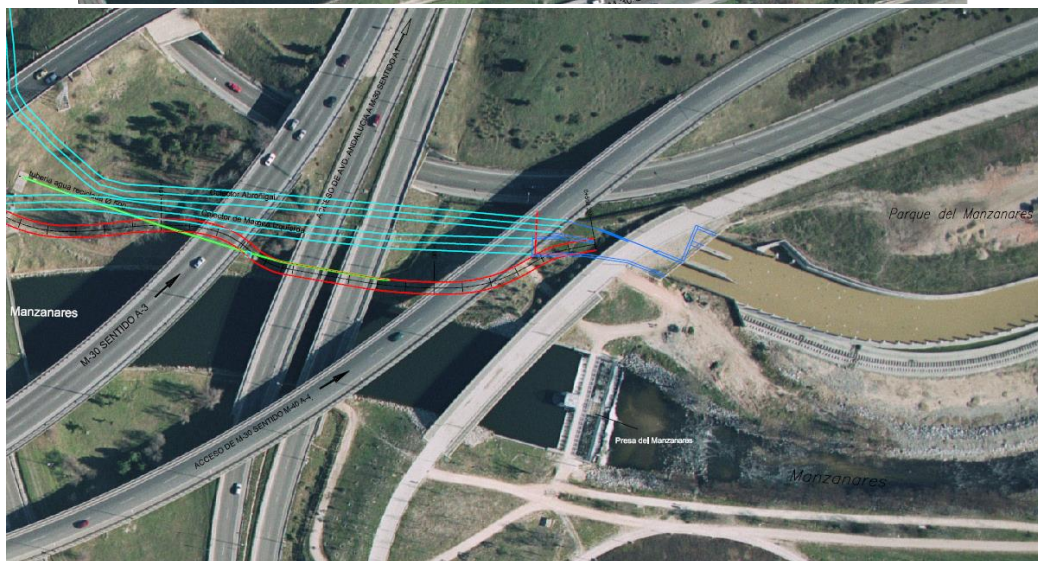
Trazado en planta del CMI N. Fuente; Proyecto Modificado N°1 del Proyecto de Construcción del Nuevo Colector de Margen Izquierda (Zona Sur). Mayo 2006
